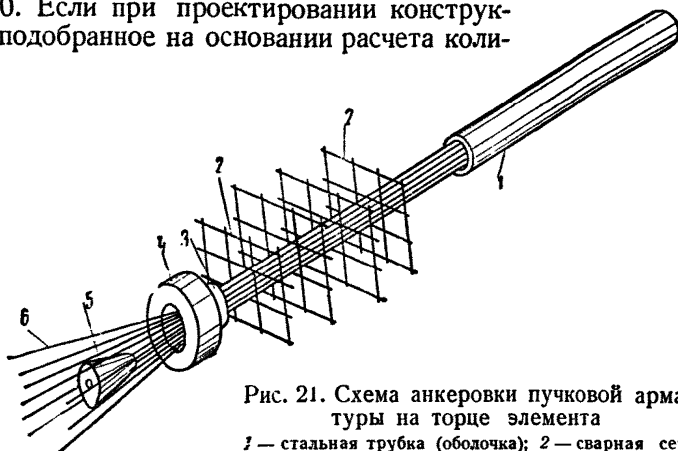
Схема анкеровки пучковой арматуры на торце элемента
